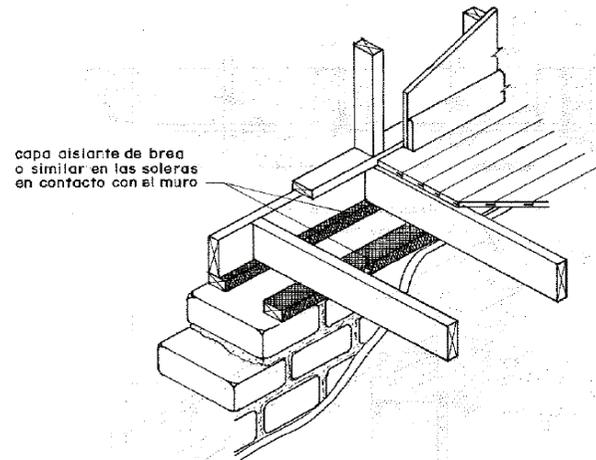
Aislamiento de la humedad en entrepiso sobre muro de adobe
